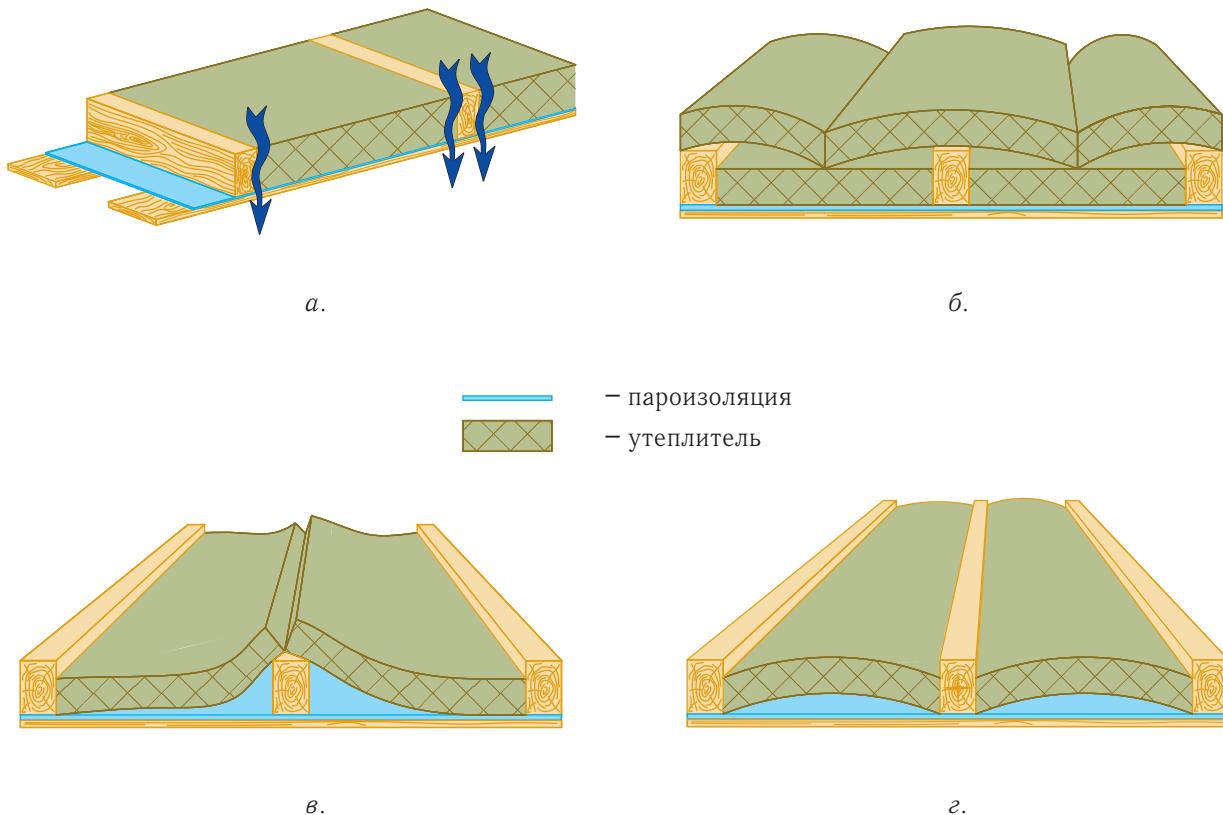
Типичные ошибки в укладке теплоизоляции,
